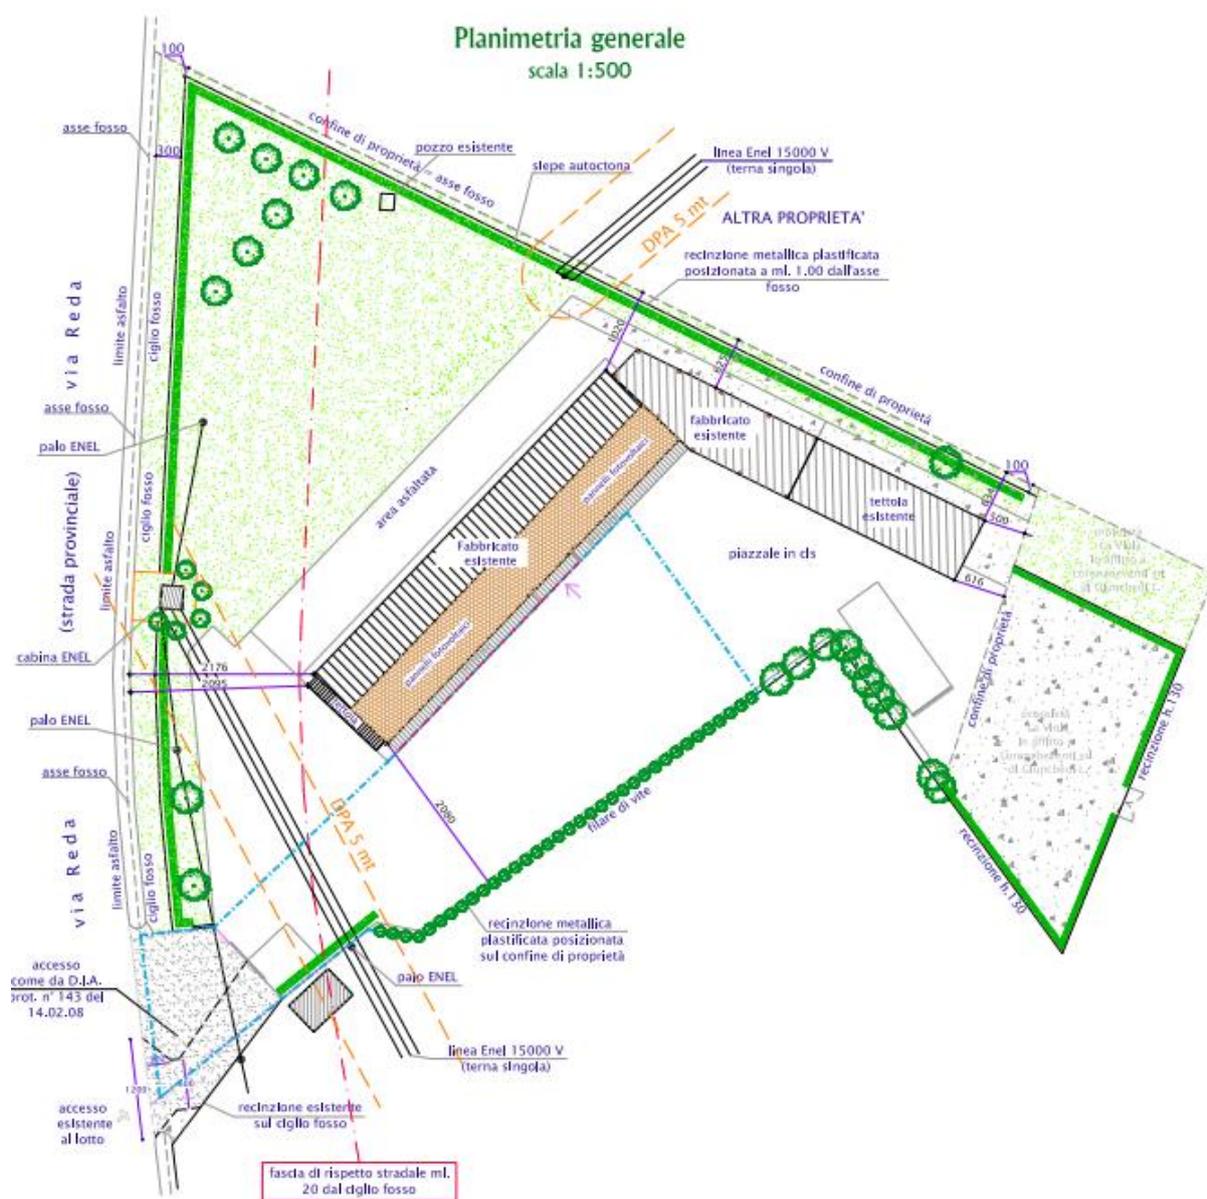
Estratto Tavola 1 - Stato di fatto legittimo - planimetria generale
